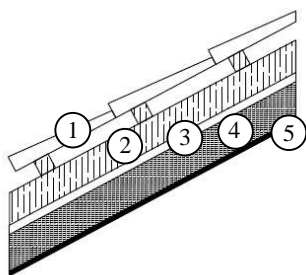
Pormenor construtivo da porposta de reabilitação da cobertura inclina sobre o desvão habitado.
